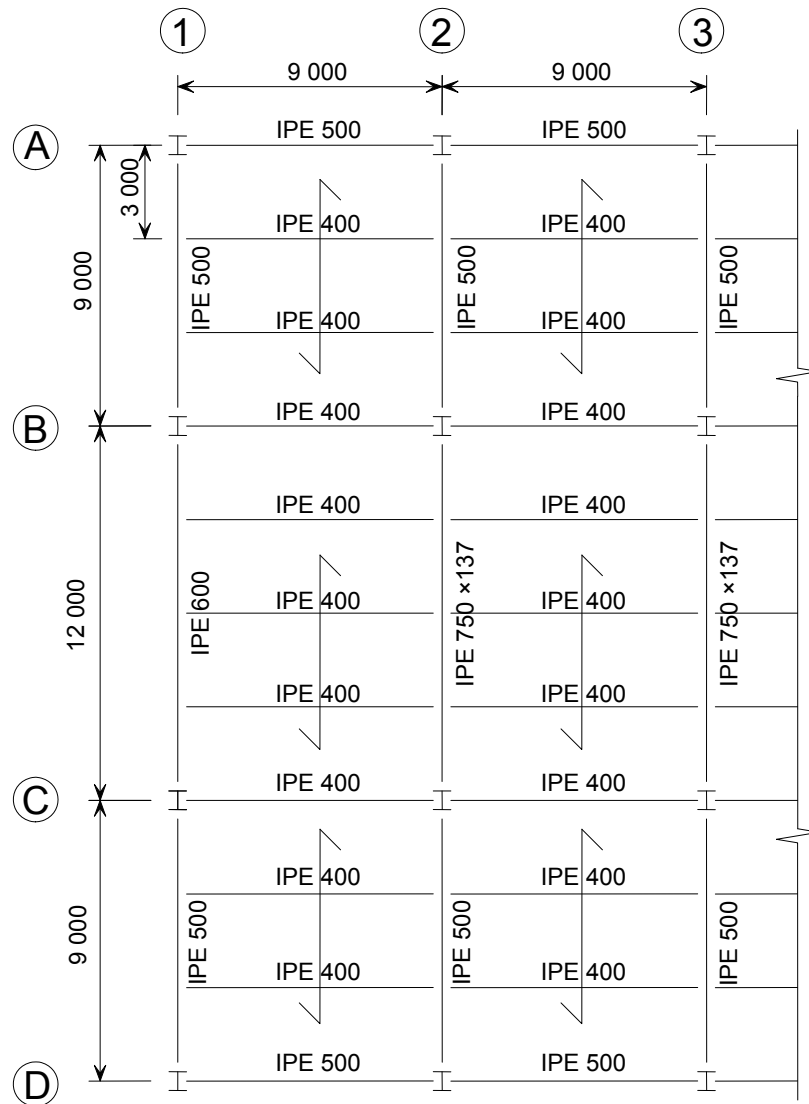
Disposition générale de la structure en acier au niveau du plancher
